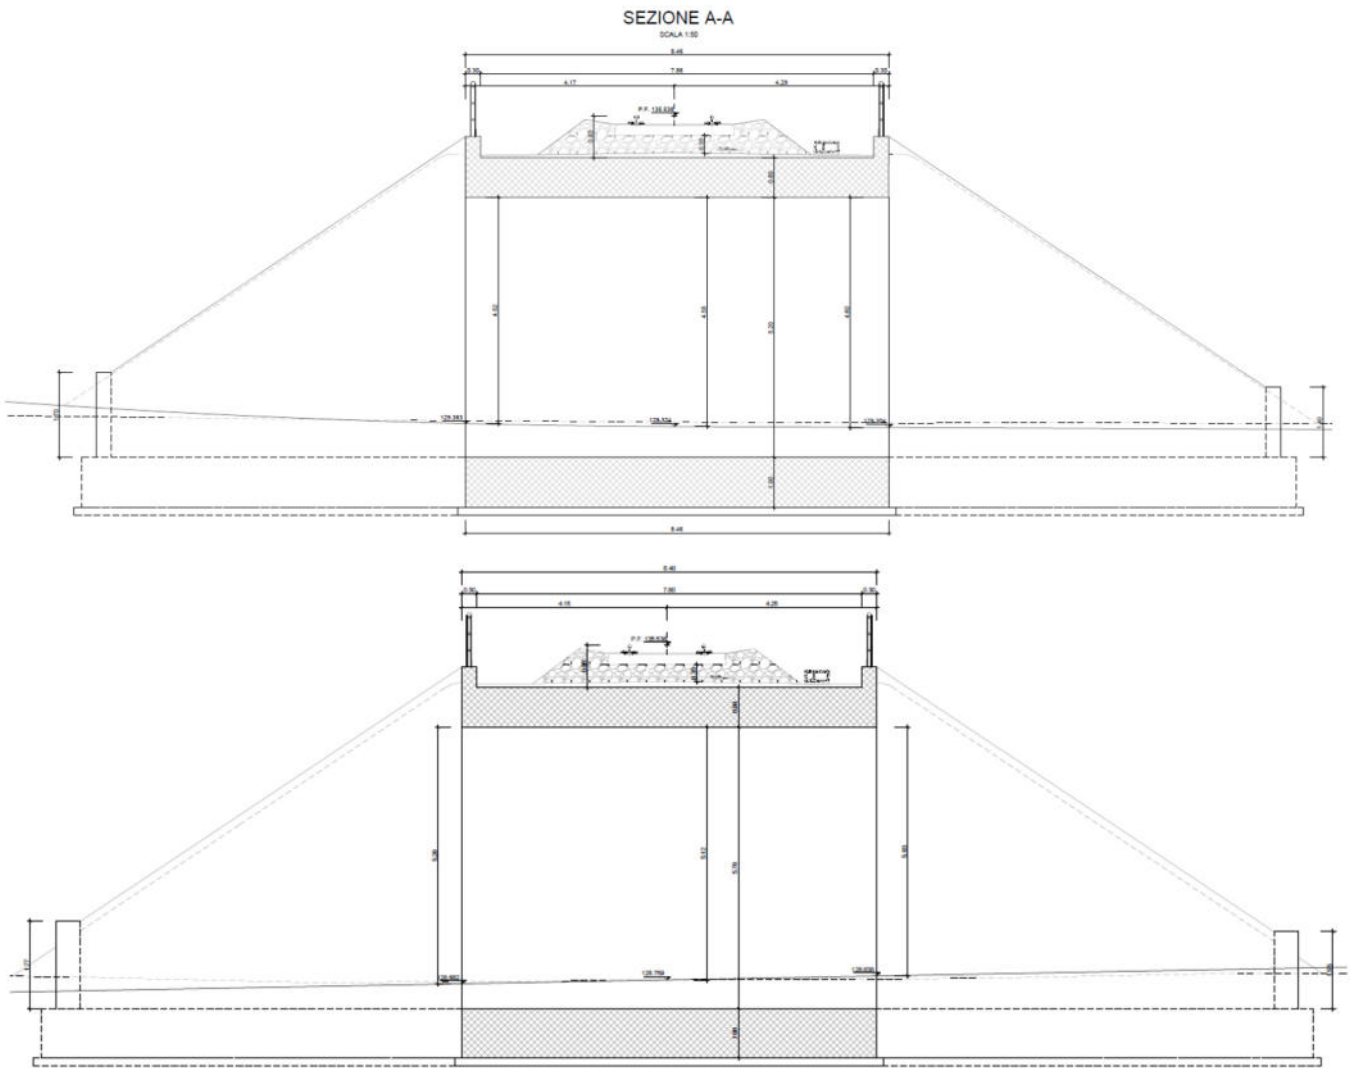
Sottovia SL01 ed SL02: Sezioni longitudinali
